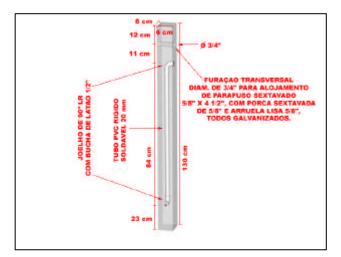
Detalhe das colunas pré-moldadas em concreto
